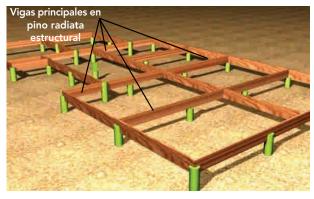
20: Ejemplo de vigas maestras o principales en entramados de piso sobre fundación aislada en Pino radiata estructural.
